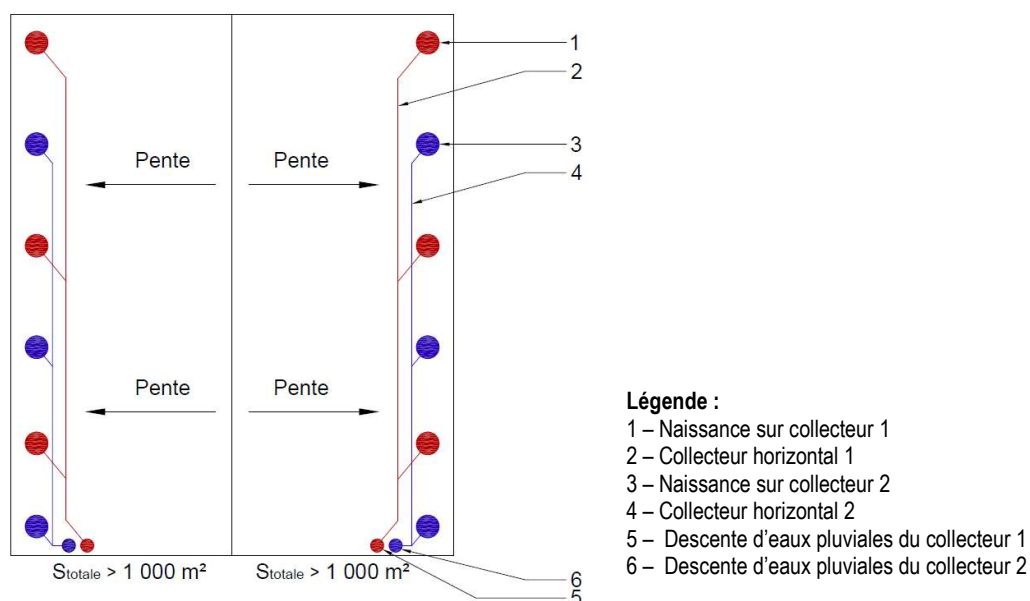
Bois - Dédoublement du collecteur et de la descente par zone de toiture desservie – Zone de toiture desservie > 1 000 m² - dispositions appliquées
